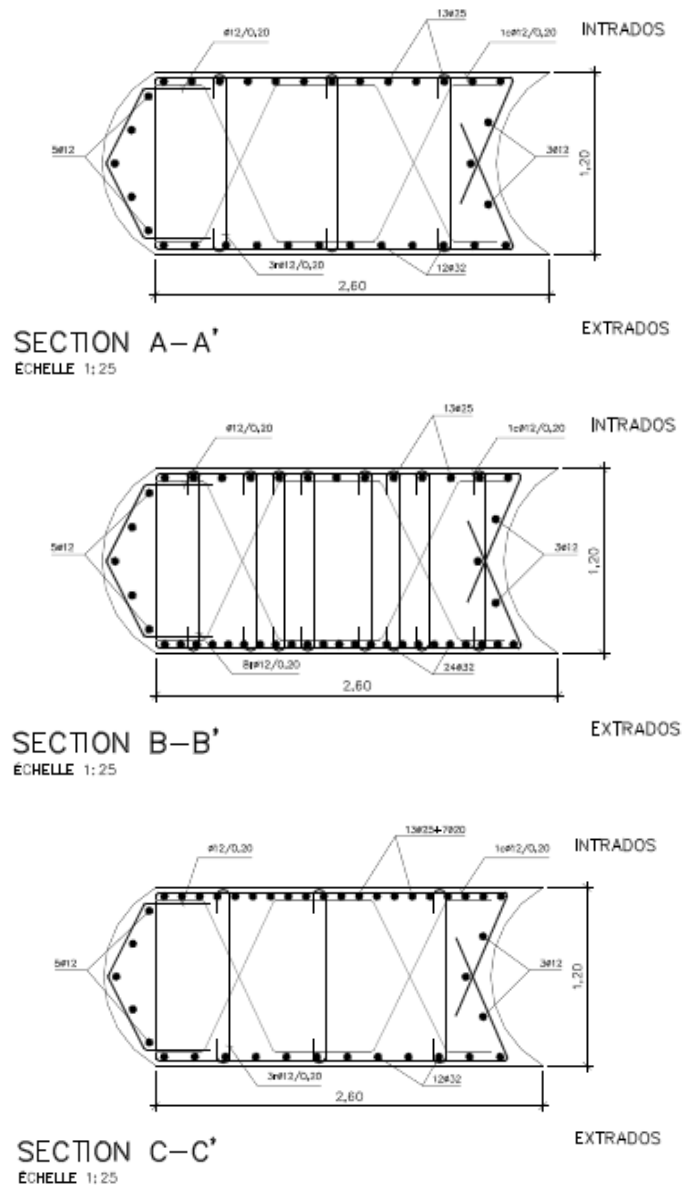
Armadura de les pantalles estabilitzades amb berma (tipus 1).
